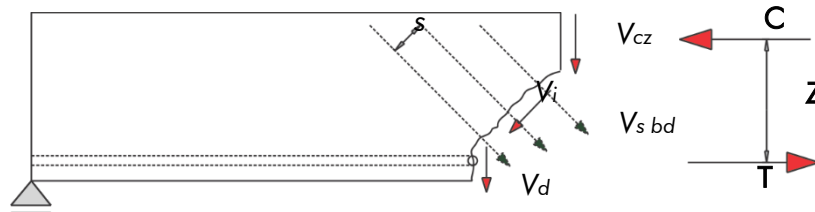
Resistencia aportada por el hormigón más las barras dobladas
